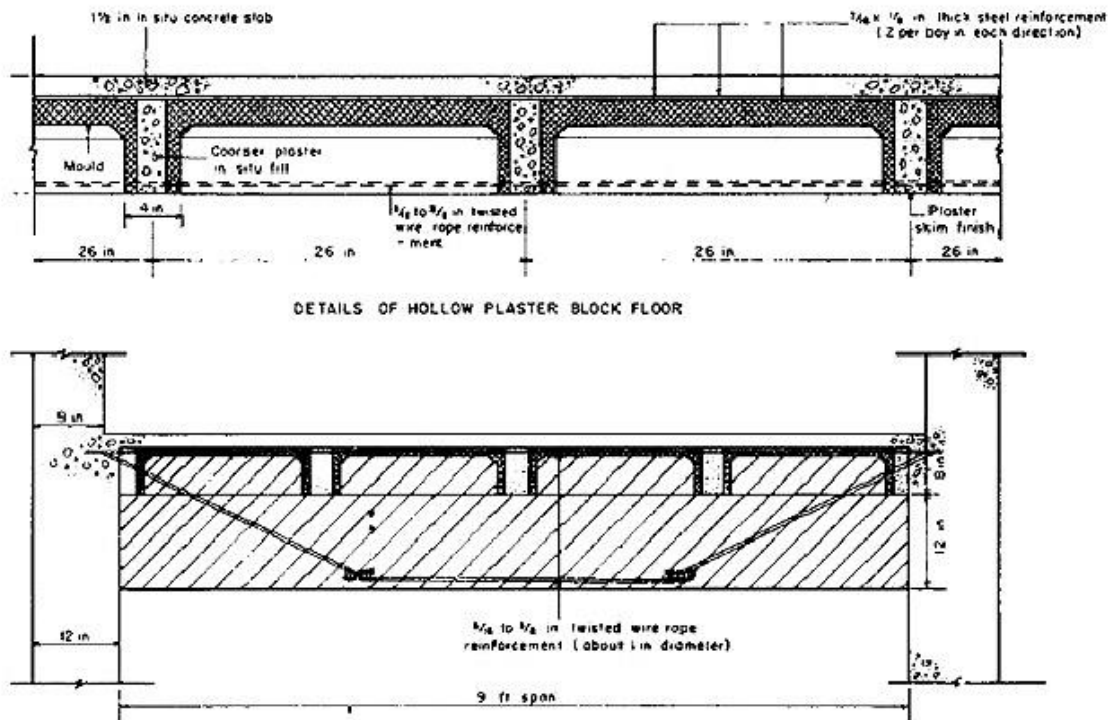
Sistema de lajes armadas com ferro, 1854 – William Boutland Wilkinson
